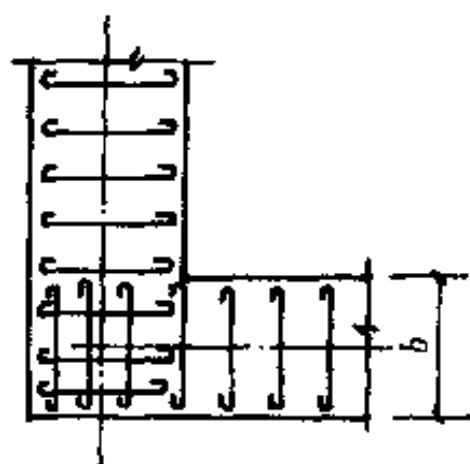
扩展基础底板拐角处受力钢筋布置示意图
